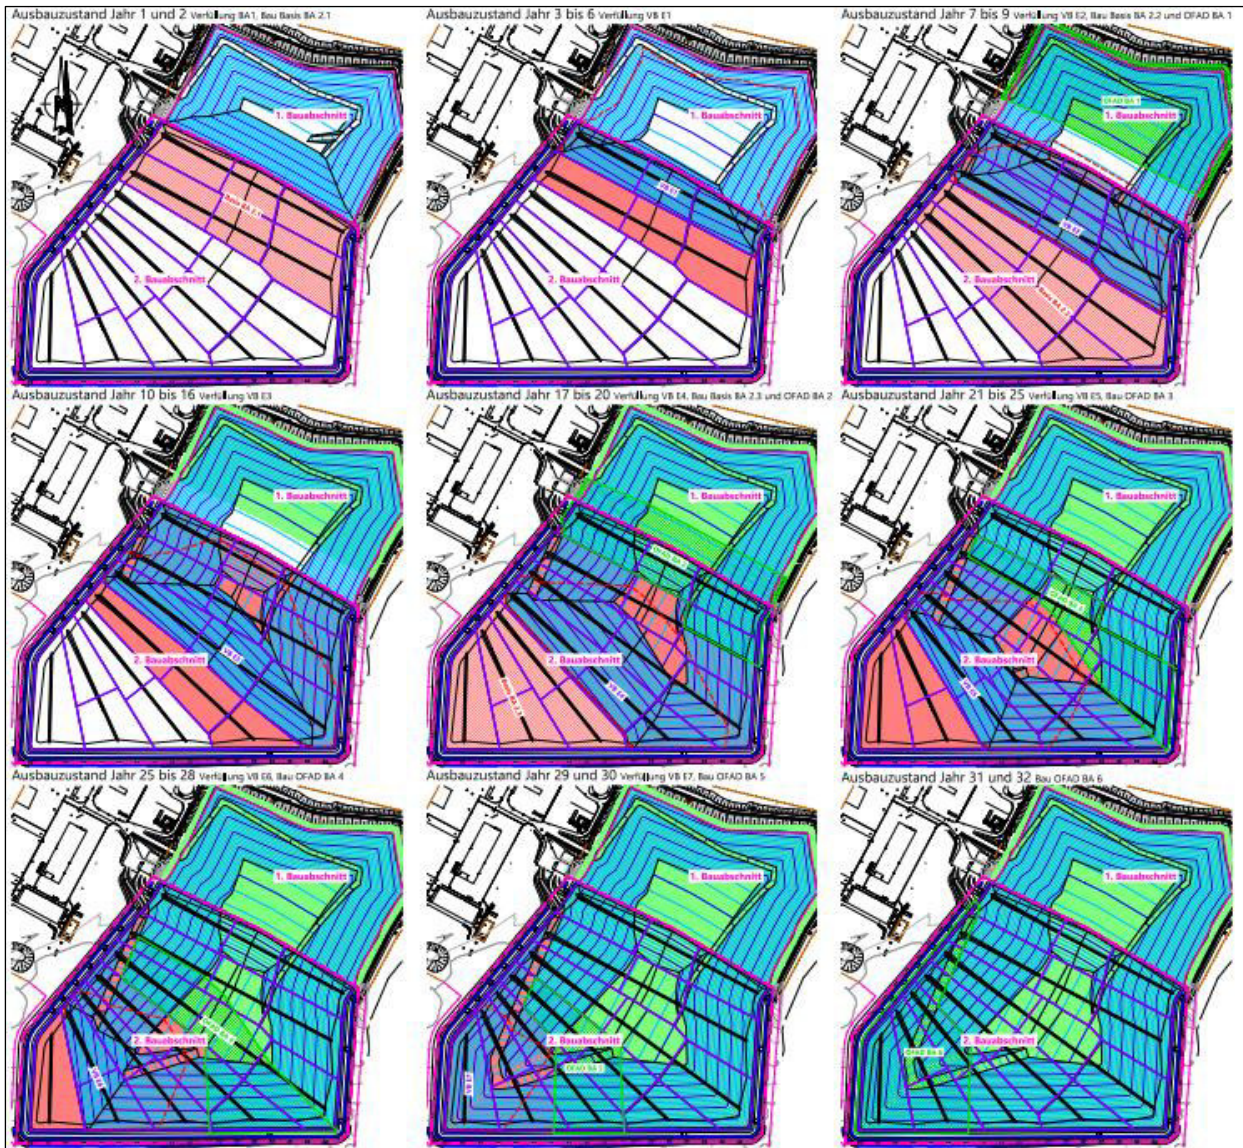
Darstellung der vorläufigen Bauablaufplanung (Quelle: Bestandslageplan 3182GP160 [88])
